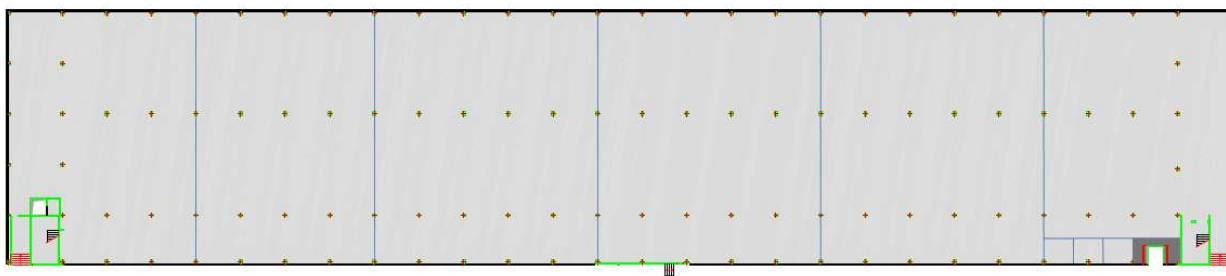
Planta da laje térrea do edifício a construir (a azul localizam-se as juntas de construção)
